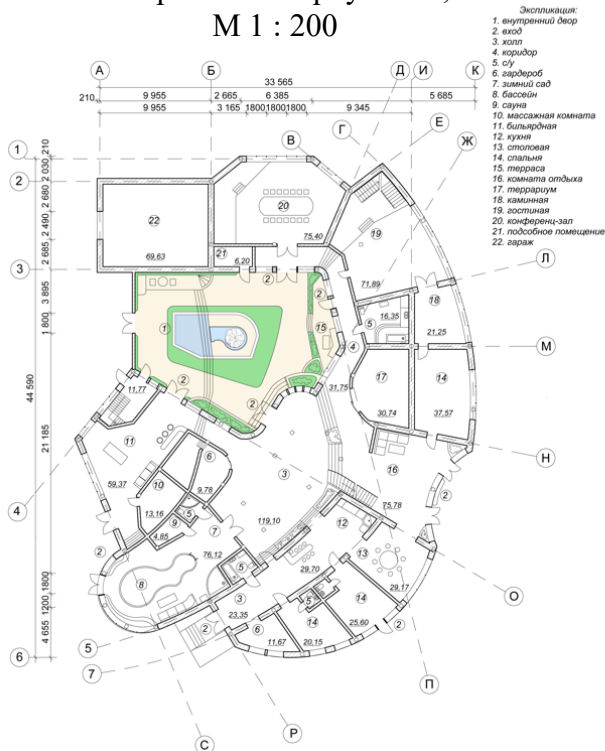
Планувальна організація житлової будівлі на відмітці + 3.000
